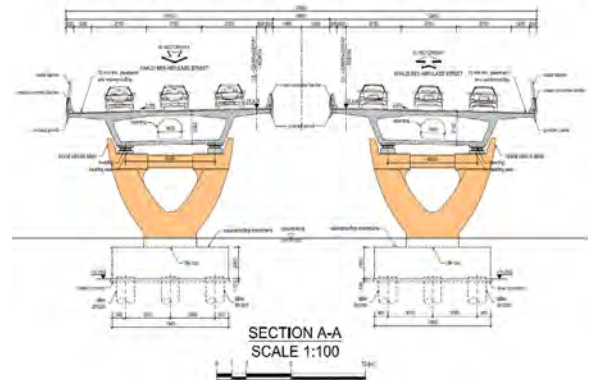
Sección de los tableros J5 Norte y J5 Sur.
